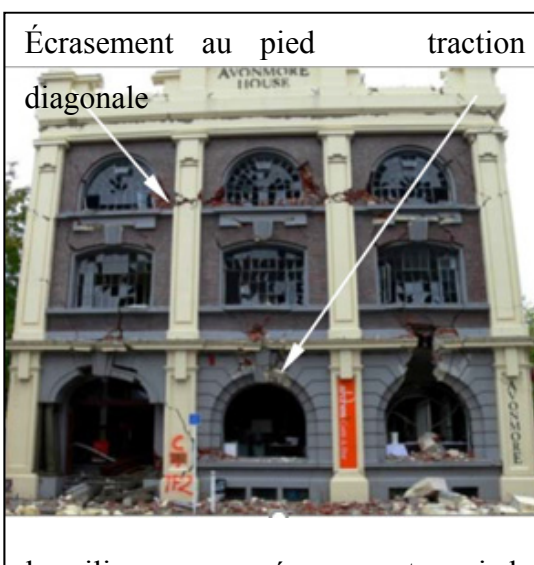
Rupture des piliers par avec écrasement au pied et traction diagonale
